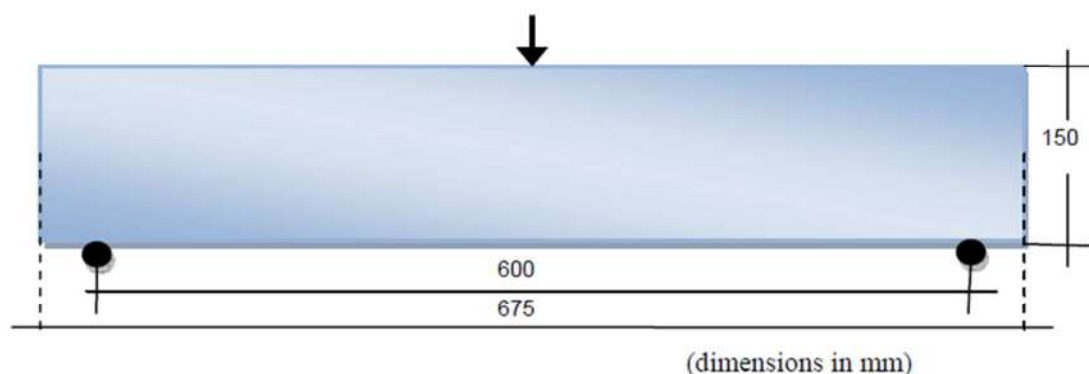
Dimensão das vigas e aplicação do carregamento. (ALMEIDA et al.,2006)
